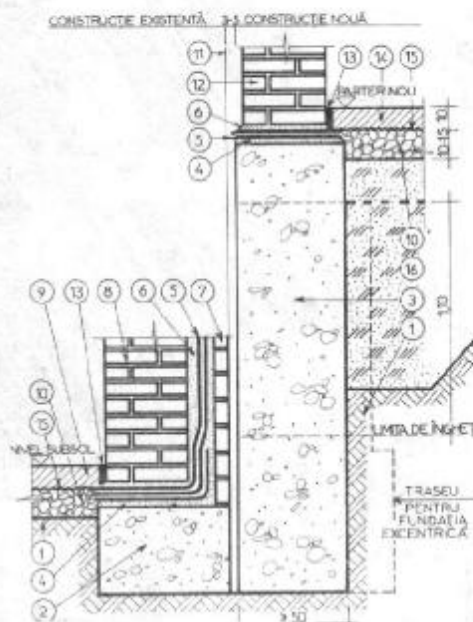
Fundație la o construcție nouă fără subsol, amplasată lângă o construcție existentă cu subsol.
